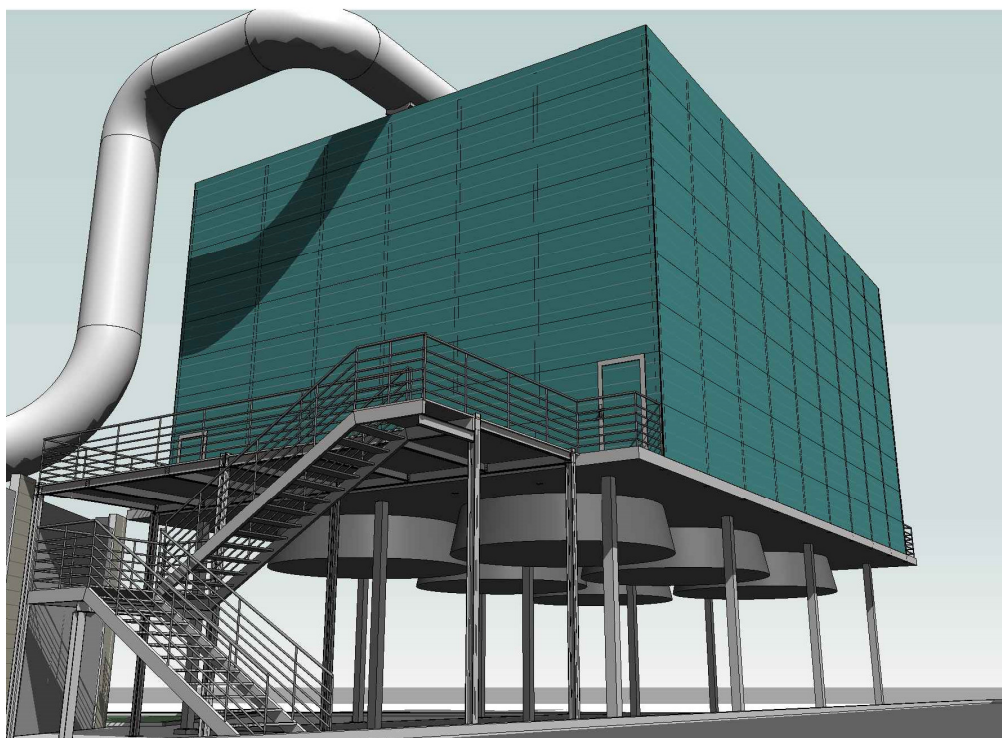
Edificio Fossa Scorie – vista prospettica esterno
